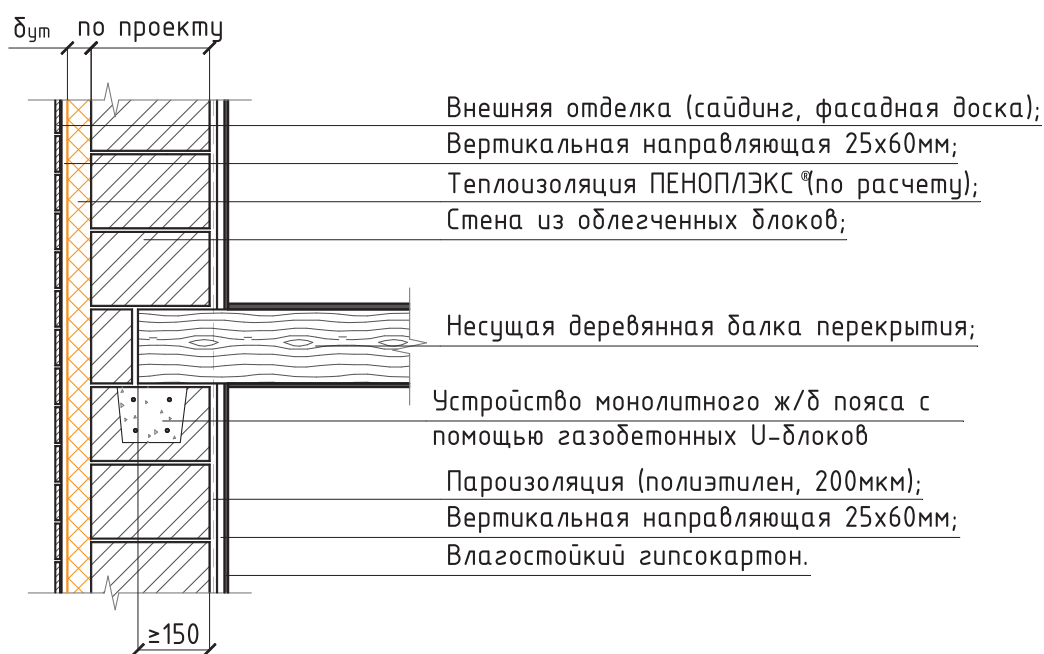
Схема сопряжения стены из облегченных блоков с деревянным перекрытием (плиты ПЕНОПЛЭКС® с внешней стороны).
